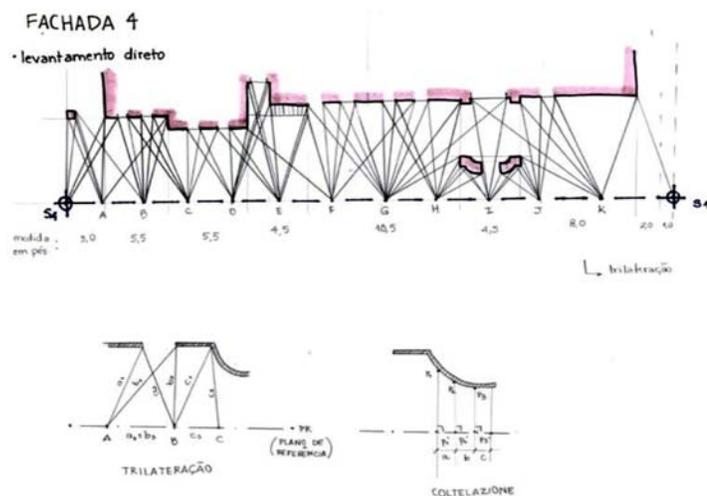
FAU-Maranhão. Fachada norte. Levantamento por trilateração a partir de linha de base.
